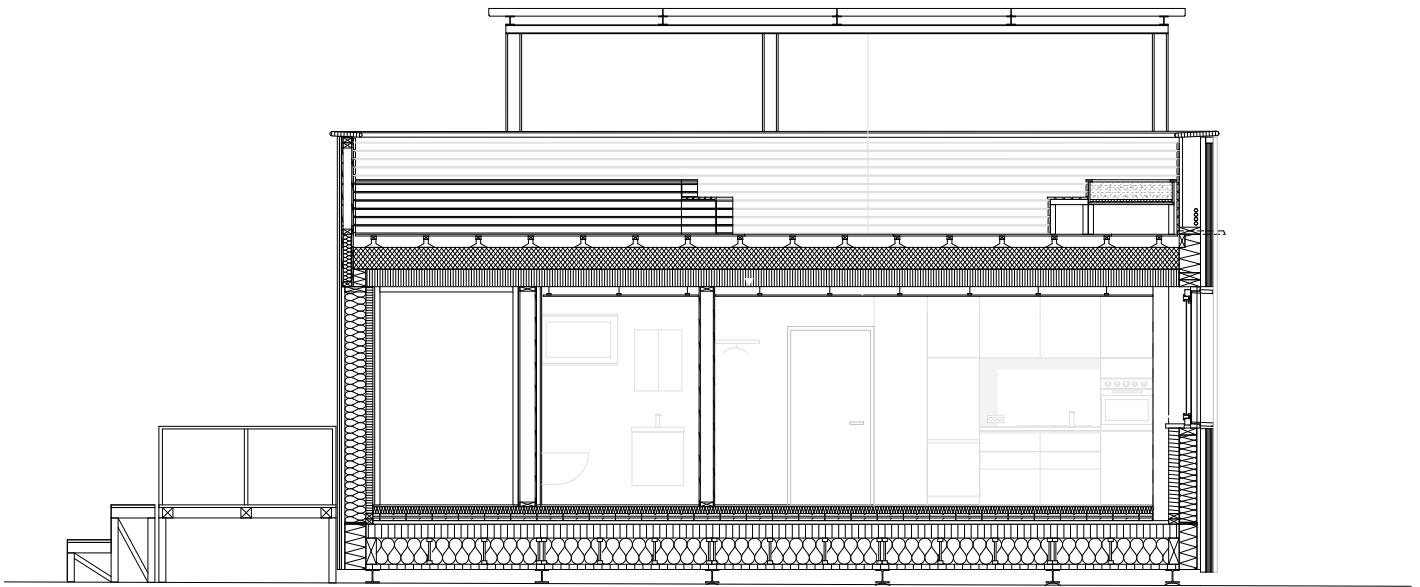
Schnitt durch HDU mit Blick Richtung Eingangssituation. Innenansicht von Küche, Badezimmer und Dachgarten
